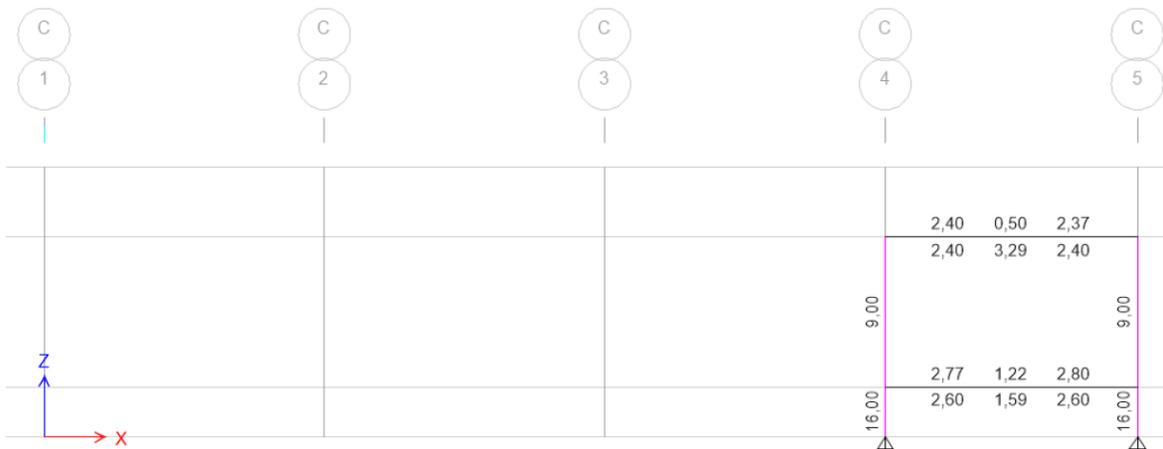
Acero requerido por columnas, pedestales y vigas del eje C (en cm<sup>2</sup>)
